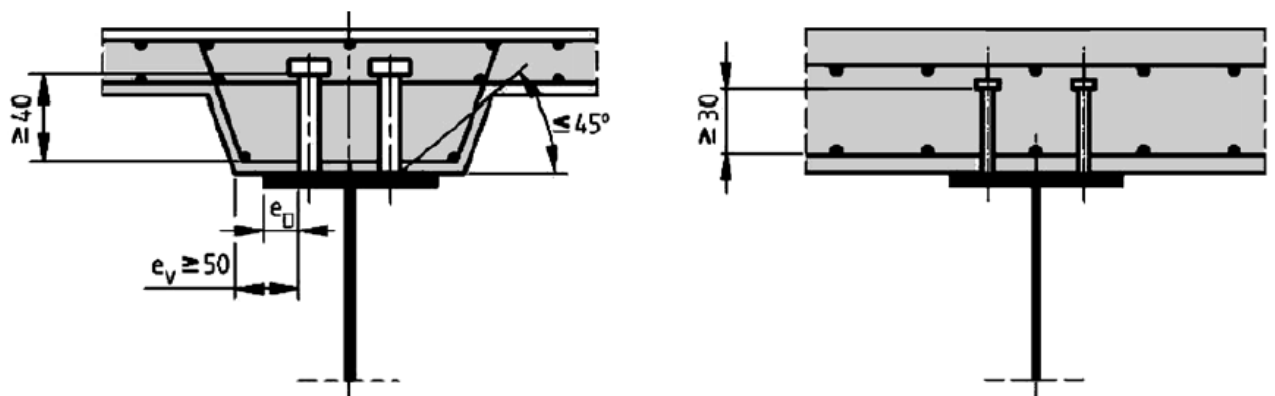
Правила конструювання вутів в бетонних плитах, що утворені не профільованим настилом
